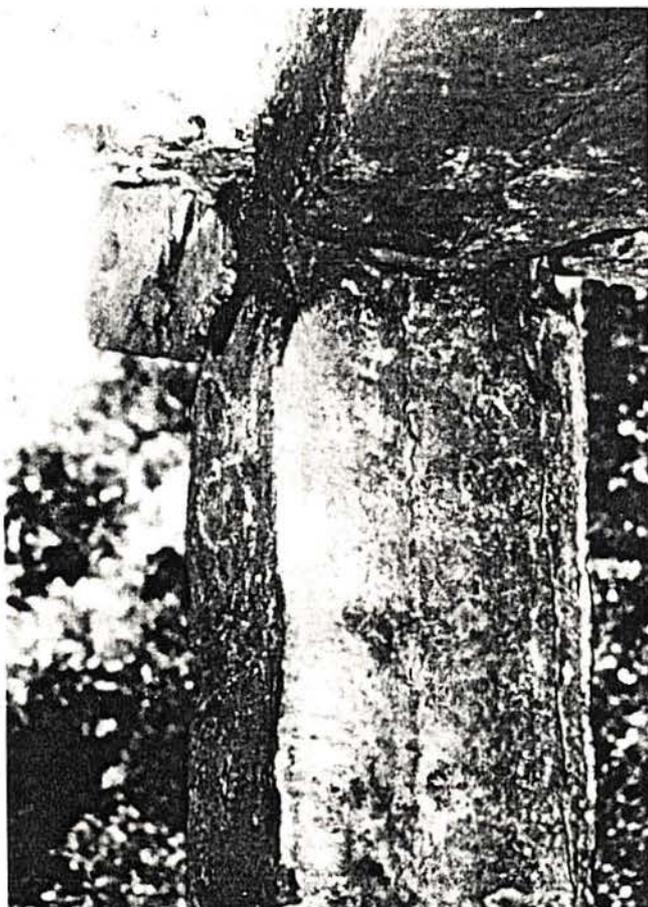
Aspecto de um pilar e vigas de um trapiche na presença de corrosão das armaduras com lascamento dos cantos do concreto do pilar devido às elevadas tensões geradas pelo processo corrosivo.
